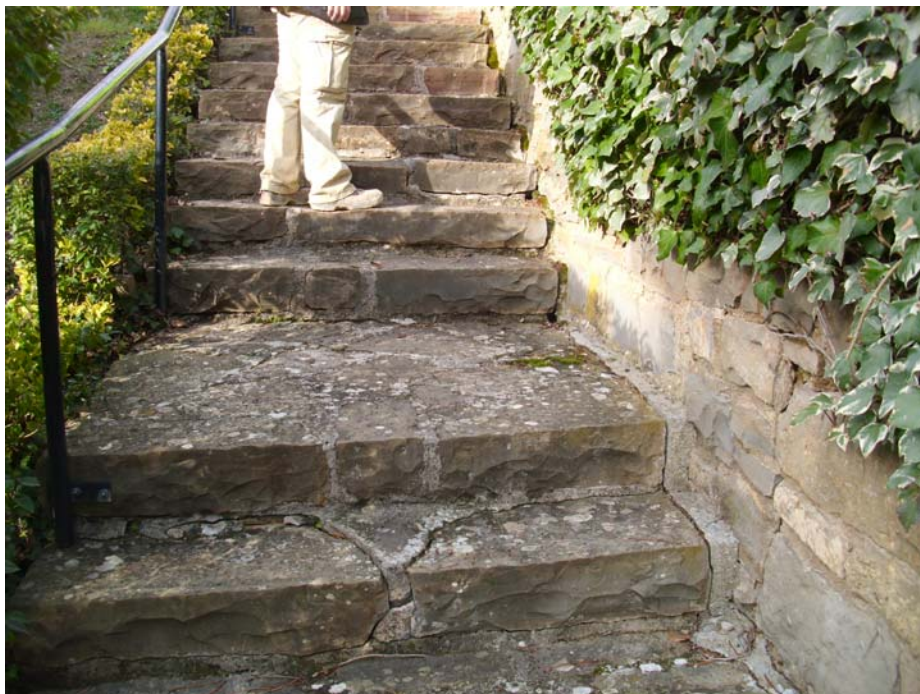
Límite Oeste de la masa inestable que provoca apertura de grietas pre existentes en muros y elementos de contención de la Urbanización Lasaitasuna. En este caso se observa la separación entre una escalera y el muro anexo. Dicha junta se encontraba previamente rejuntada con mortero.
